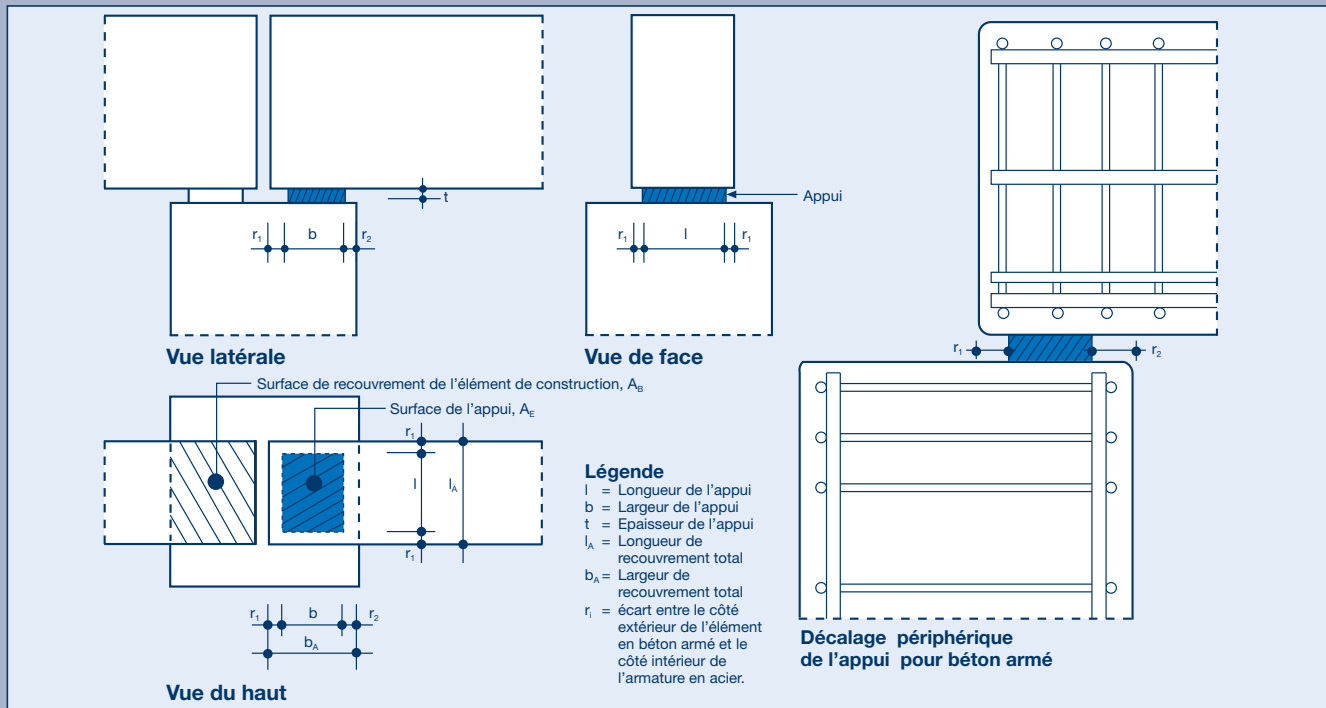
dimensions maximales de la surface d'un élastomère compte tenu des distances latérales conformément au cahier 600, Comité allemand de la construction en béton armé (Deutscher Ausschuss für Stahlbetonbau). En construction métallique, la distance latérale jusqu'à l'arête extérieure de l'élément doit être d'au moins 10 mm.
